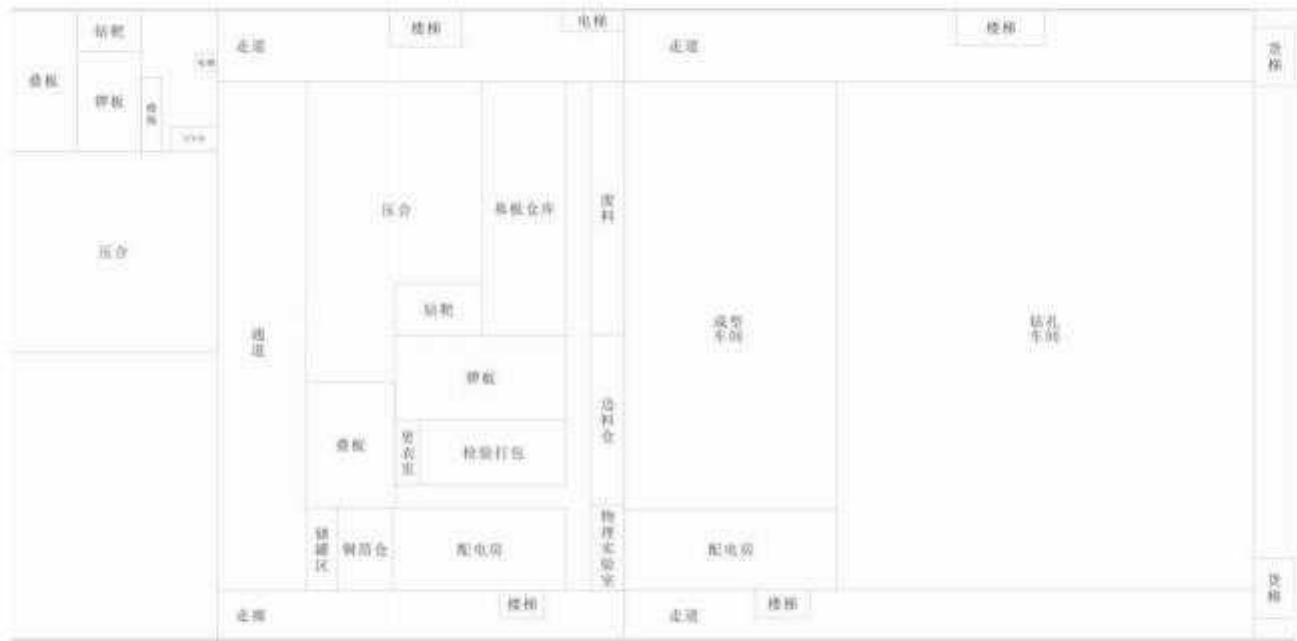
项目厂房 2.3.4 一层平面布置图
